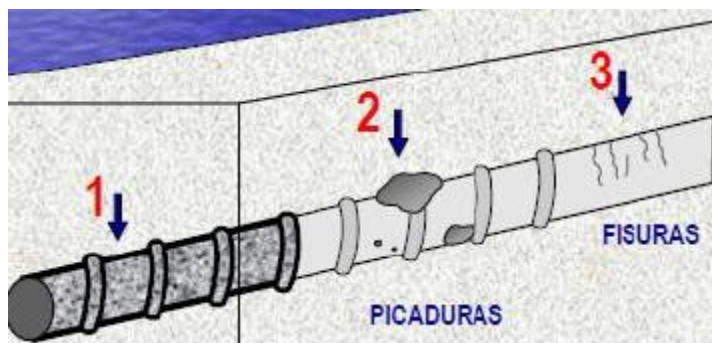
Tipos de fisuras presentes en el acero de refuerzo.
